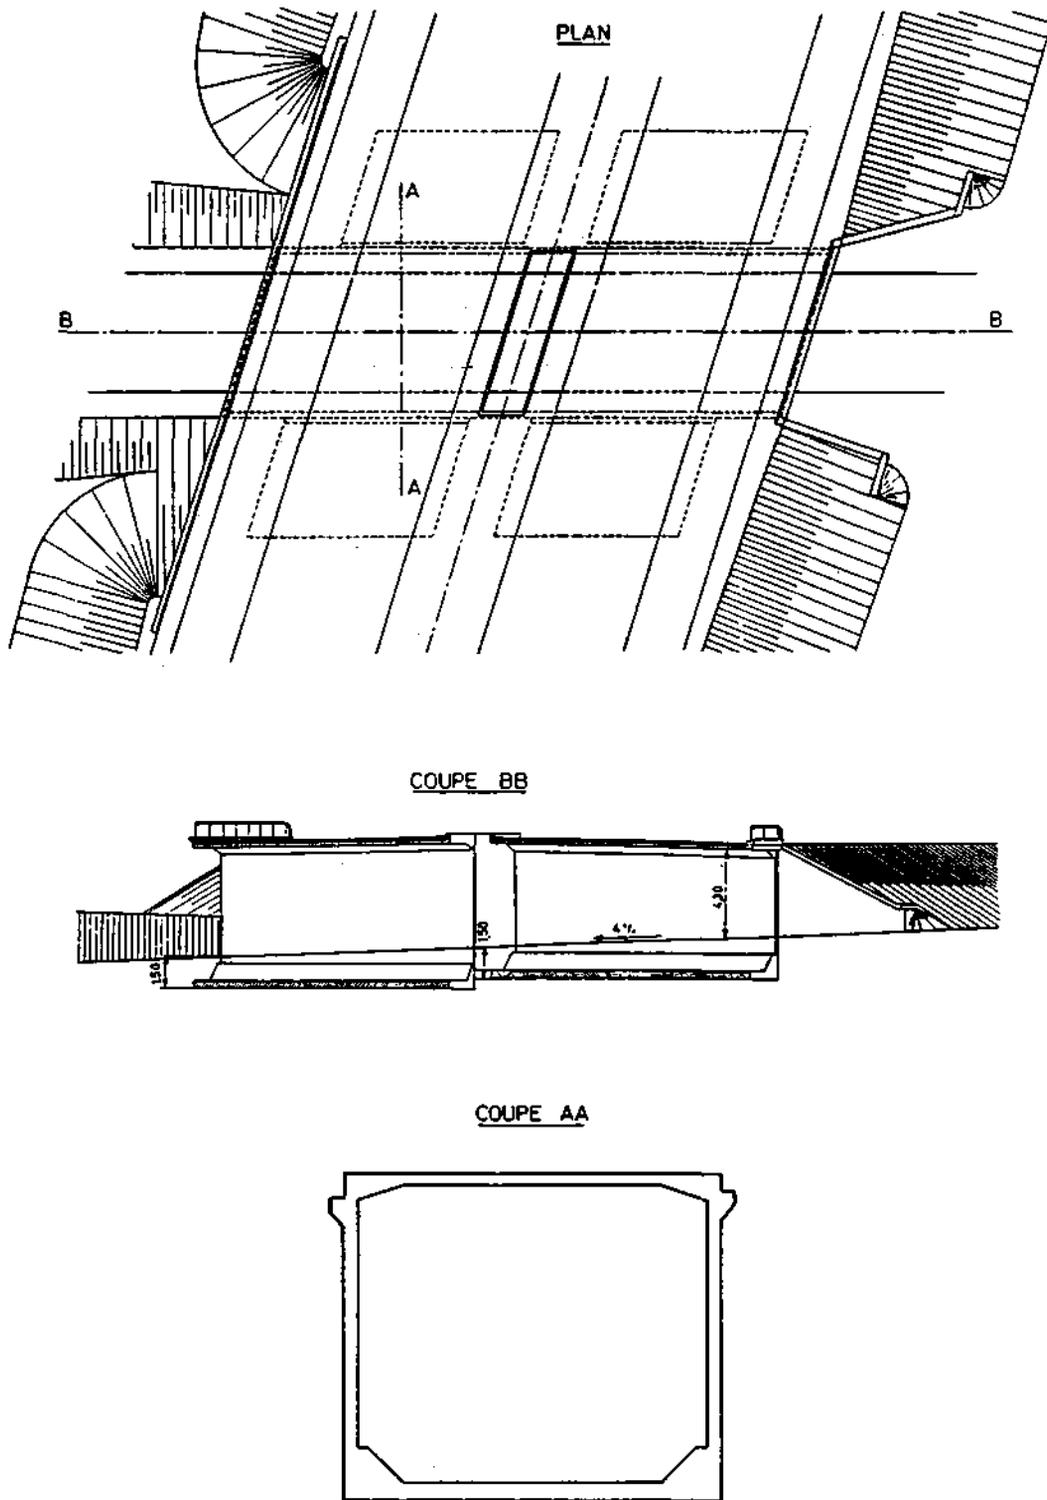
Calage de l'ouvrage (cas d'un pont-cadre)
